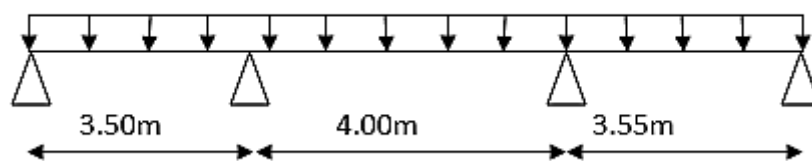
Schéma statique de la poutre continue reposant sur 04 appuis
